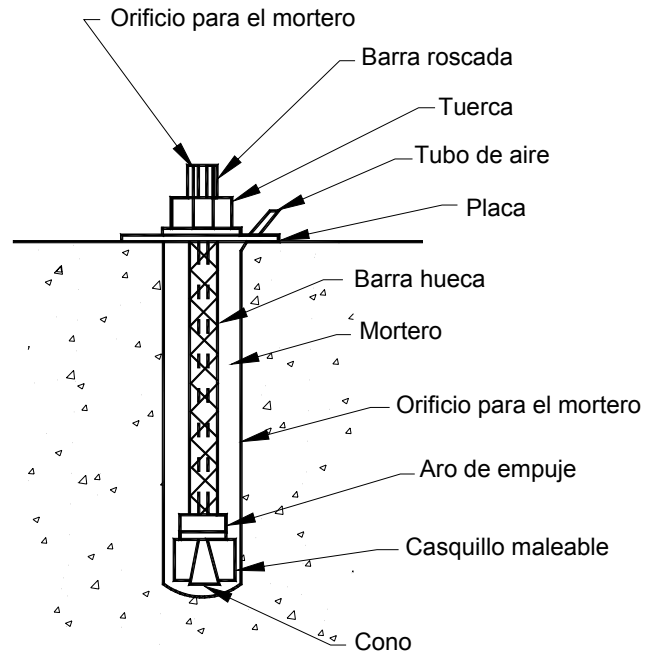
Anclaje de expansión para roca/hormigón (cementado con mortero)
